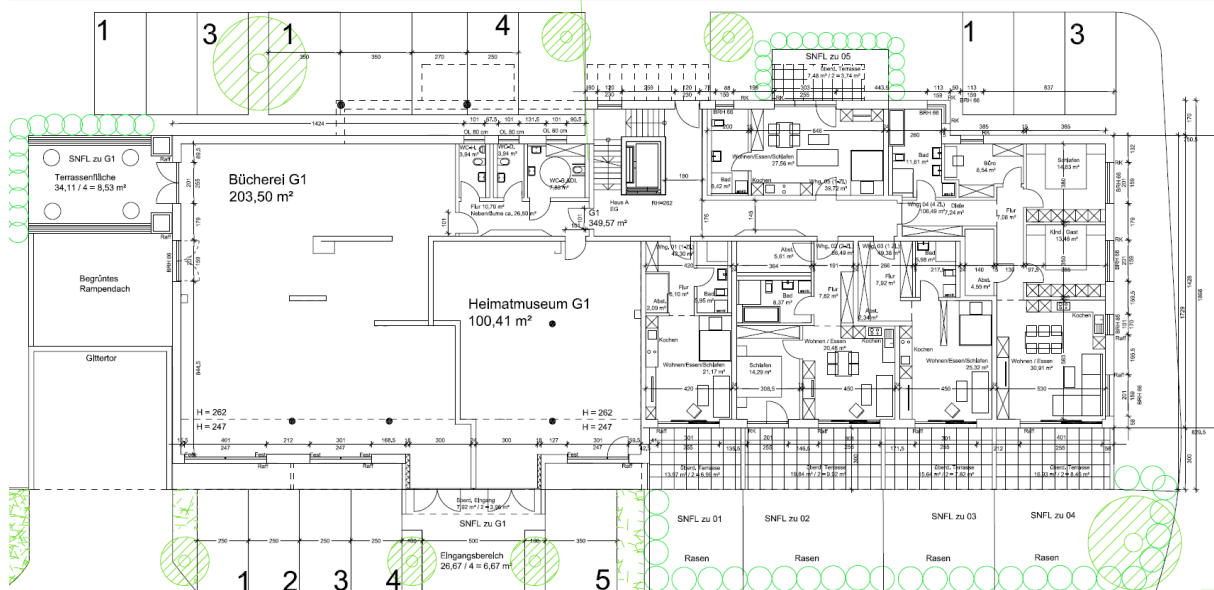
Vorhaben Grundriss Erdgeschoss Gebäude 2 [12]
